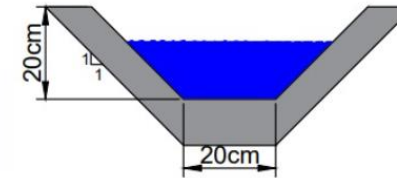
Sección tipo drenaje longitudinal. Fuente: Elaboración propia.
